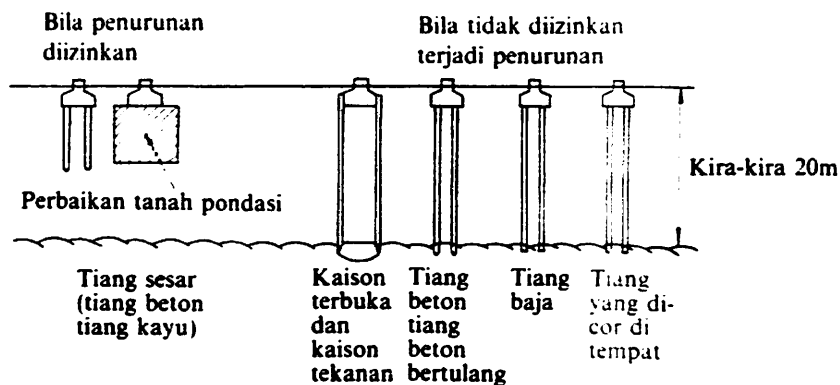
Contoh-contoh pondasi bila lapisan berdekatan pondasi cukup dangkal (Sumber: Soderstrom, S., dan Nakazawa, K., 2000: 73)
